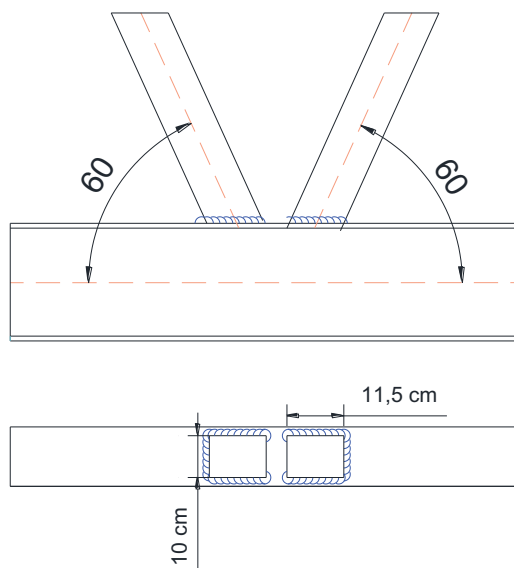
Vista frontal y lateral de soldadura en la celosía
